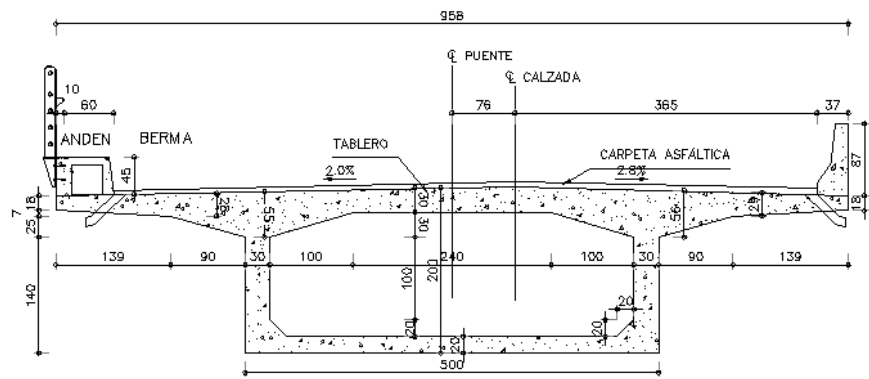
Sección transversal centro de luz - Puente Bermúdez
